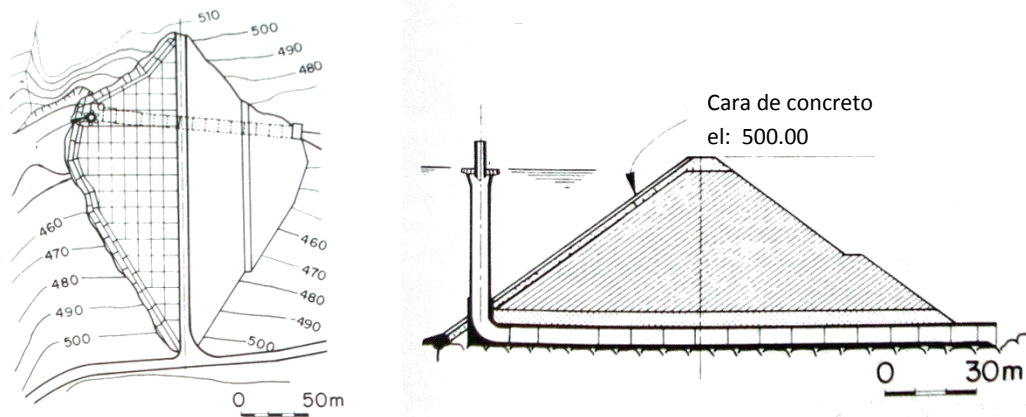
Vista en planta y sección de una cortina de ECC, Referencia 1
